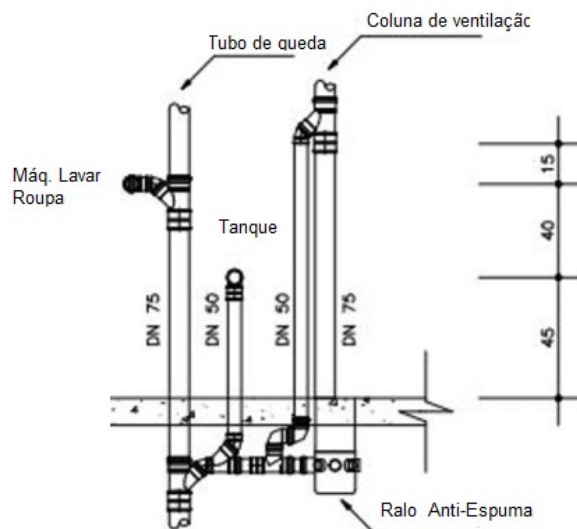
Detalhe da ligação da parte inferior da coluna de ventilação no tubo de queda abaixo do primeiro pavimento.
